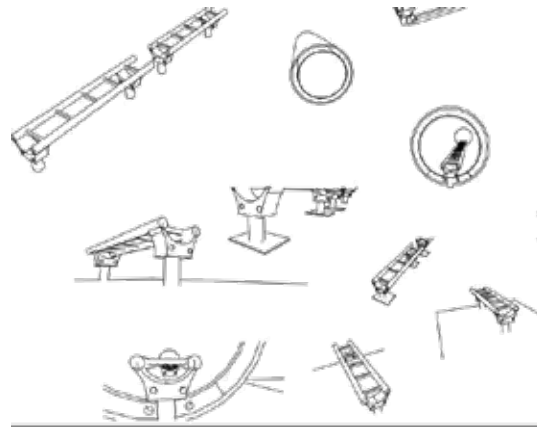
Detalles de Montaña rusa. Fuente: la autora (2018)
